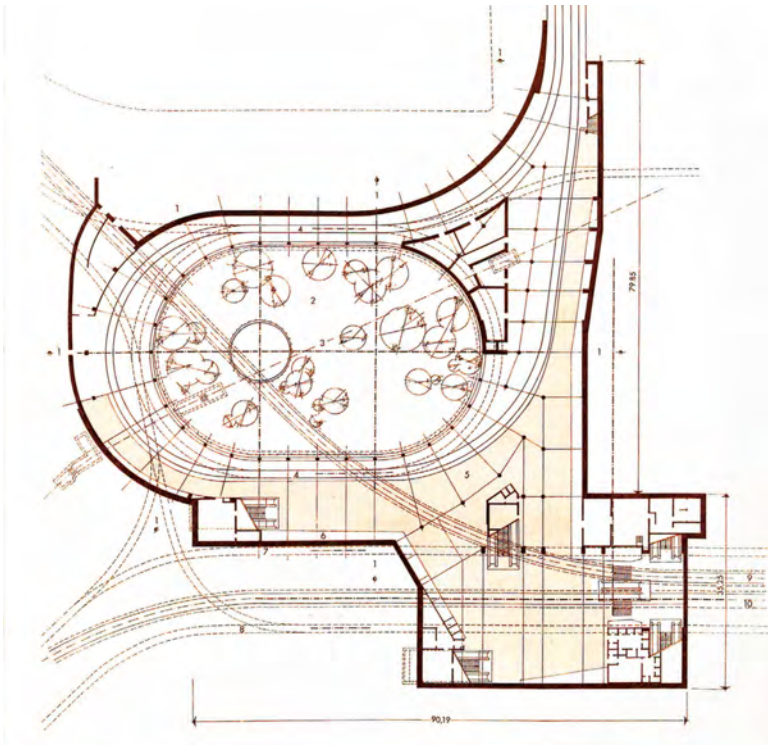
Kurt Schlauss mit Magistratsabteilung 28: Schottenpassage, Grundriss des Untergeschosses, 1961.
